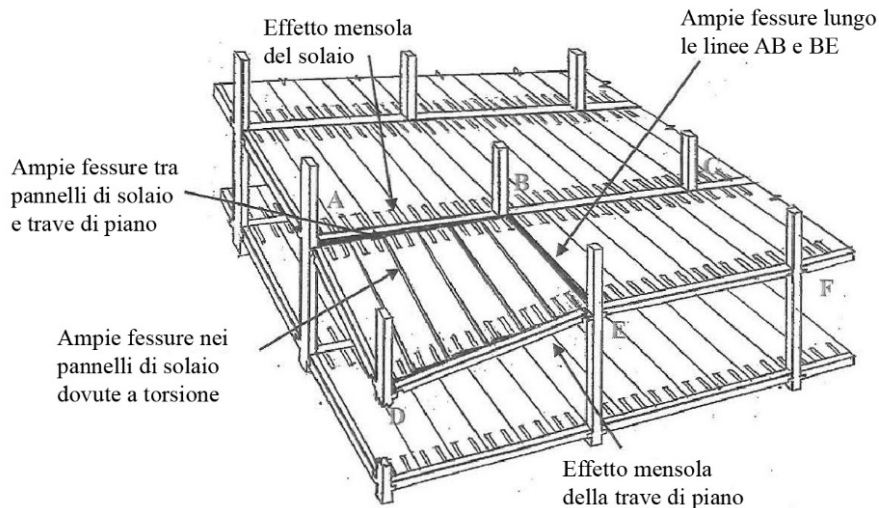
Effetto del collasso di un pilastro d'angolo (da fib, 2012)
